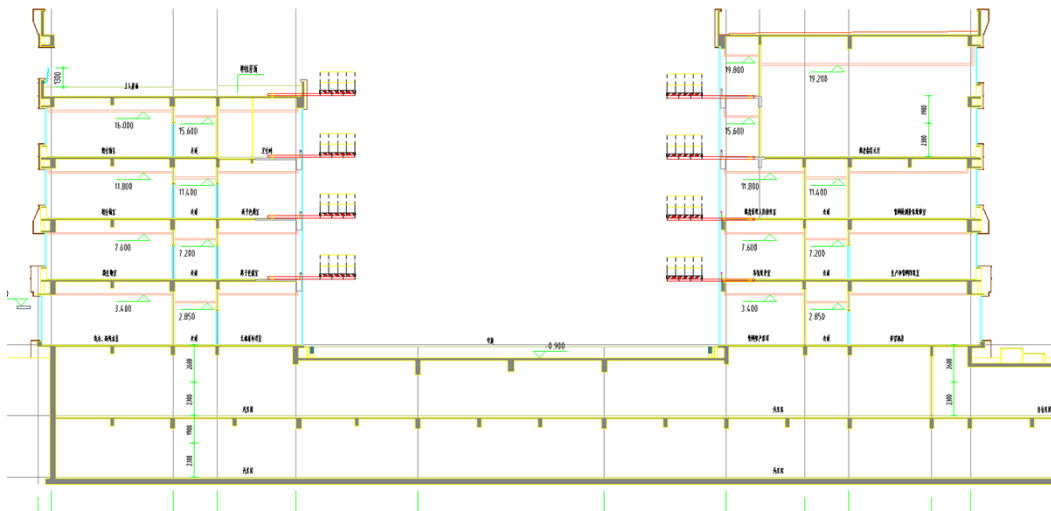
智慧水务中心悬挑式卸料平台布置立面图
